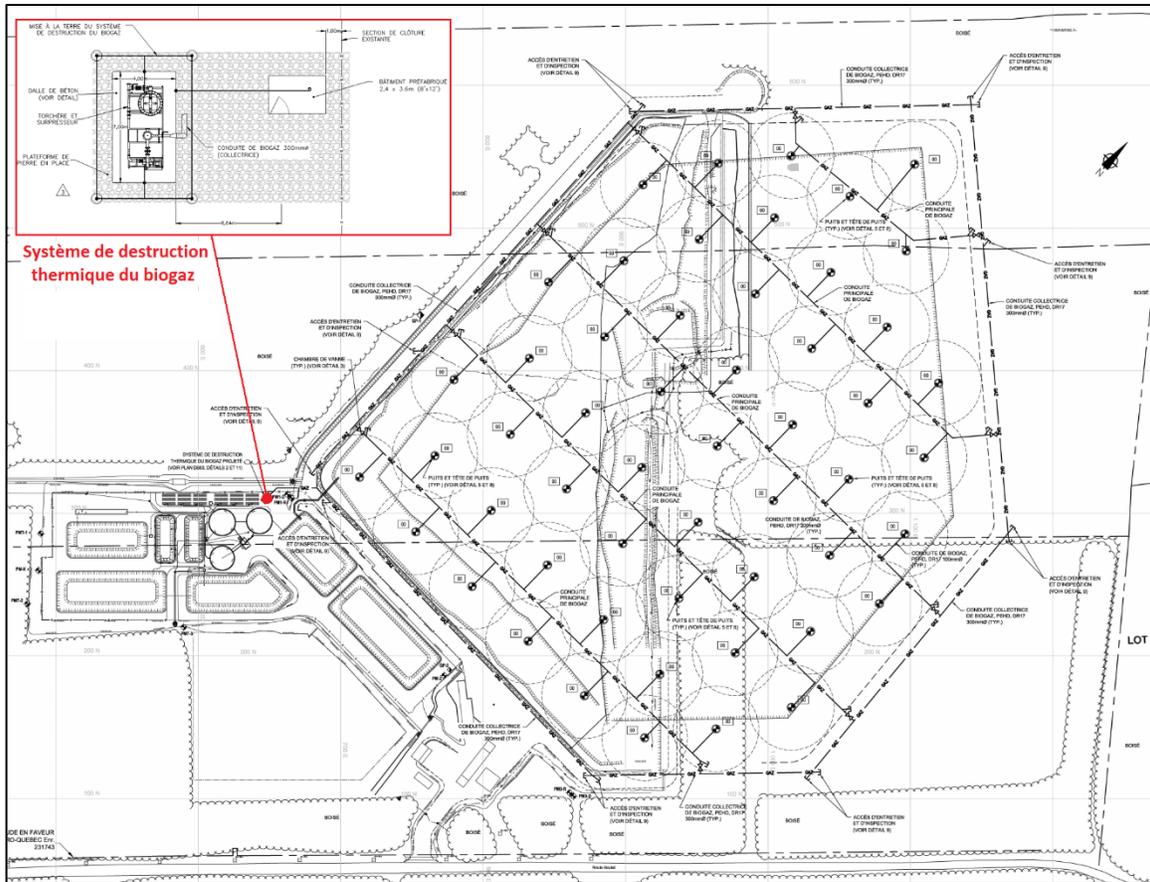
Site d'enfouissement et système de collecte et de destruction du biogaz
